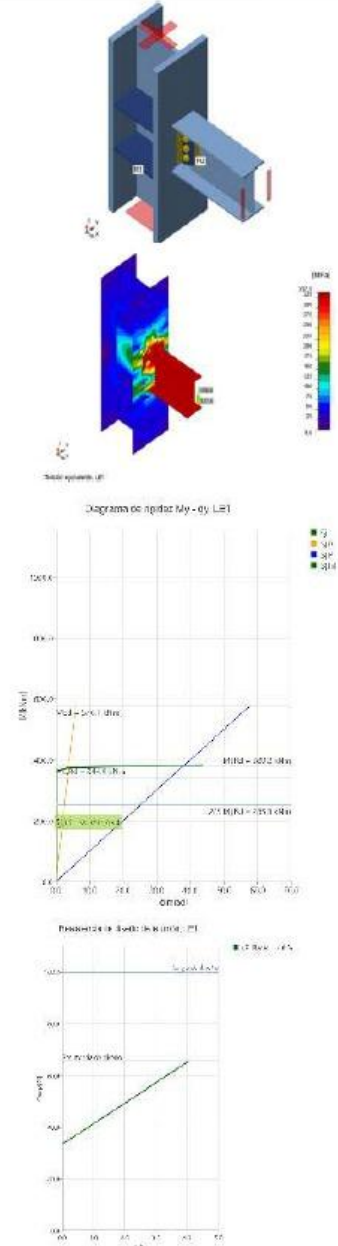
Detalles generales de la conexión alma de viga a alma de columna.
